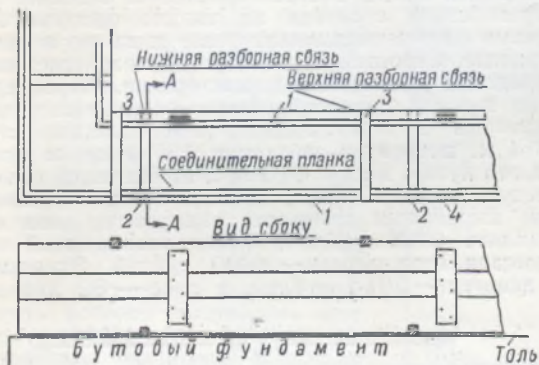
План части фундамента и опалубки: 1 — щиты опалубки из 30-мм досок, длиной до 6,5 м; 2 — нижние разборные связи сеч. 6×5 см; 3 — верхние разборные связи; 4 — соединительные планки.
